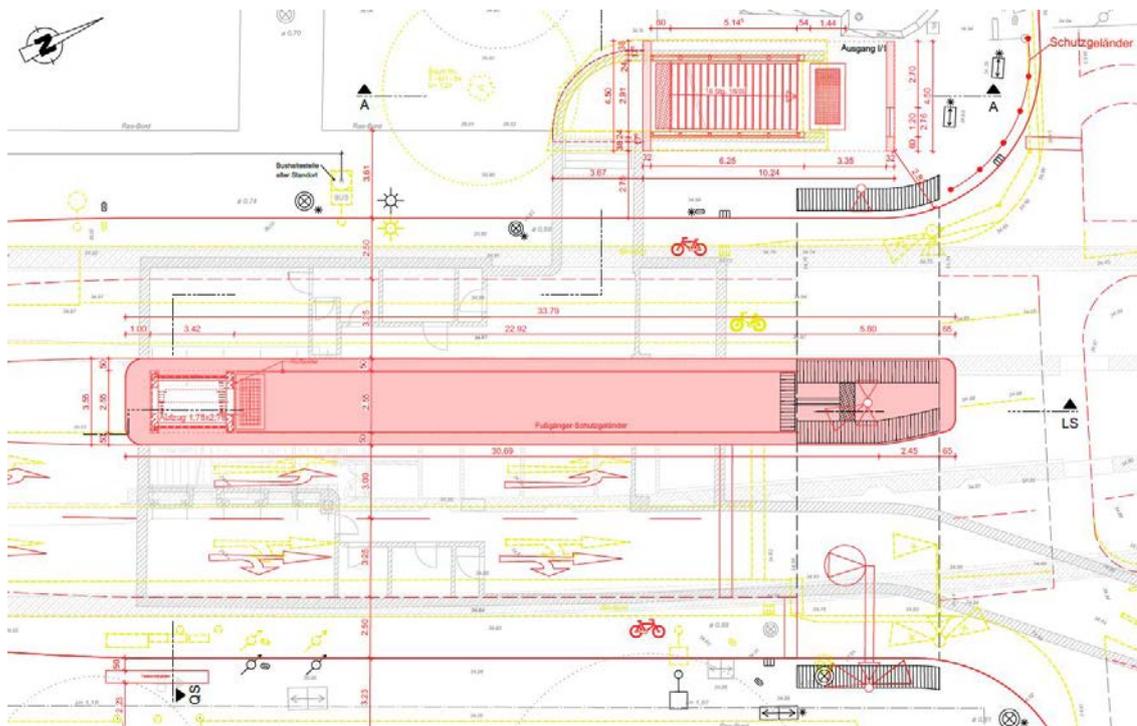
Vorzugsvariante, Ausschnitt Plan He\_PG002
